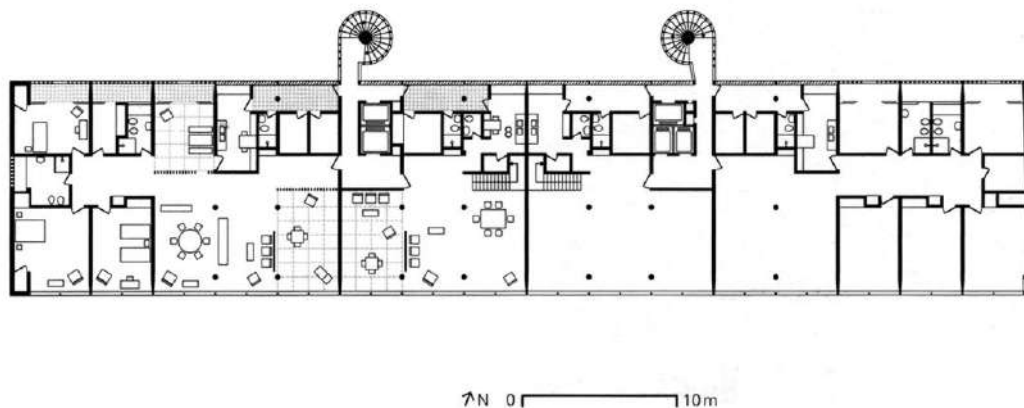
Planta do 2º, 4º e 6º pavimentos do Edifício Nova Cintra
